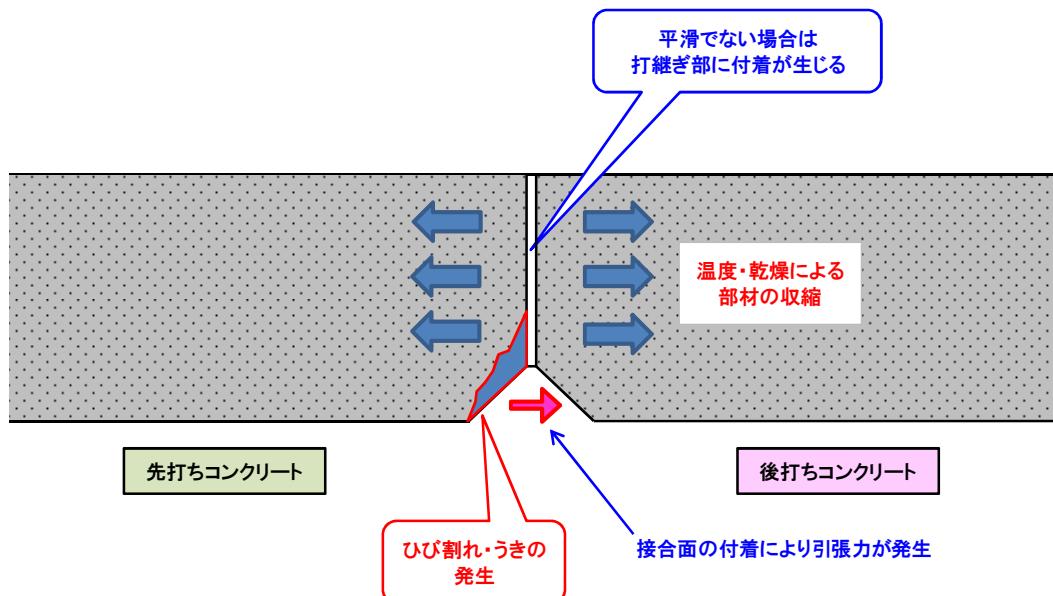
施工目地部の付着力によるひび割れ発生
